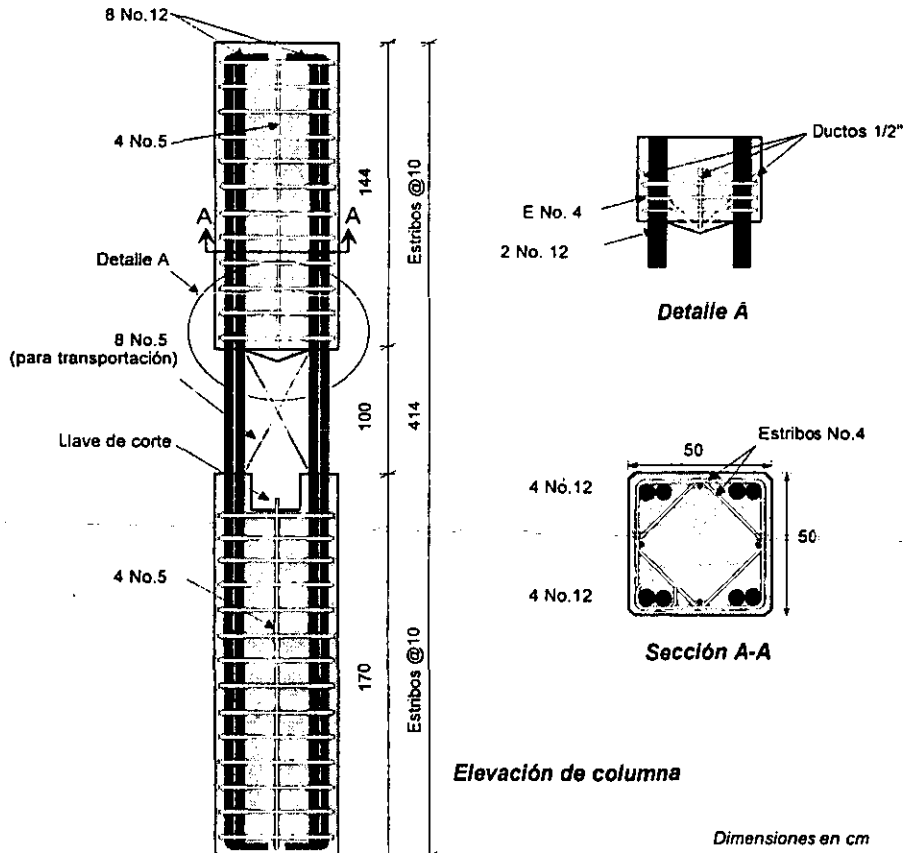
Geometría y armado de la columna del modelo J-AP
